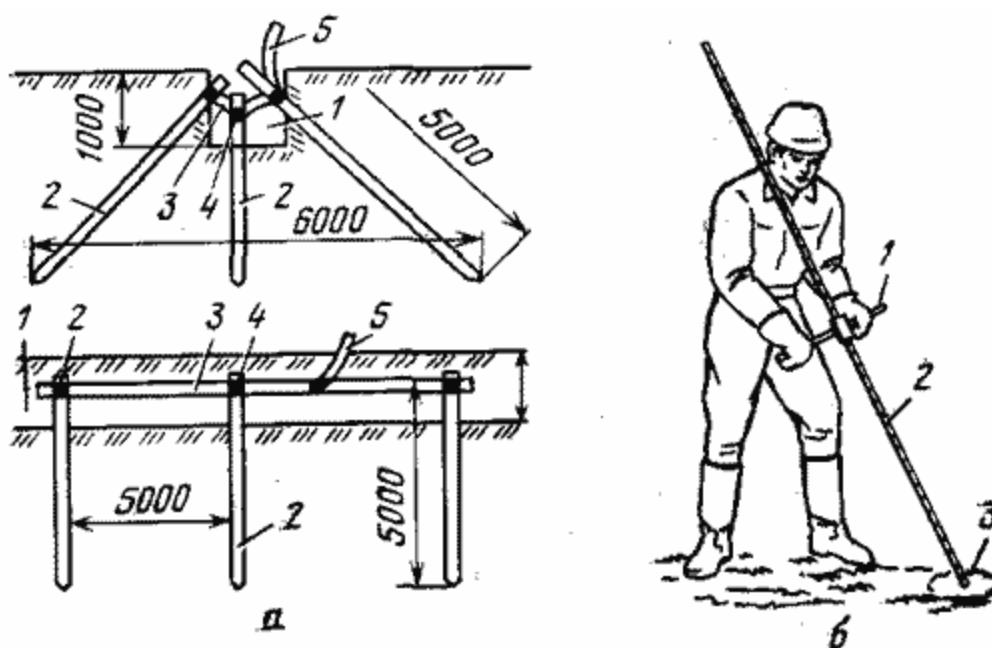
Монтаж заземляющего устройства КТП: а) – конструктивные размеры заземляющего устройства из наклонных и вертикальных заземлителей: 1 – траншея; 2 – заземлители; 3 – перемычки; 4 – сварные соединения; 5 – заземляющие проводники; б) – техника погружения наклонных заземлителей вручную: 1 – переставная ручка; 2 – штык; 3 – вода.
